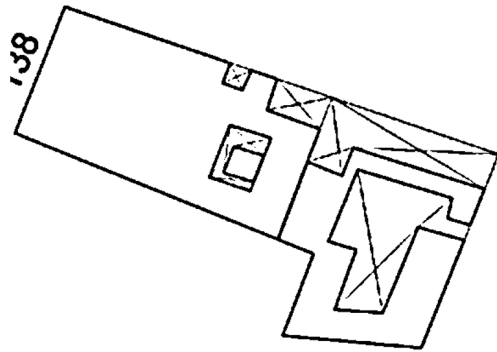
Plano que muestra el área construida en el inmueble en el año de 1935 (Archivo de SEDUVI, 2014)
